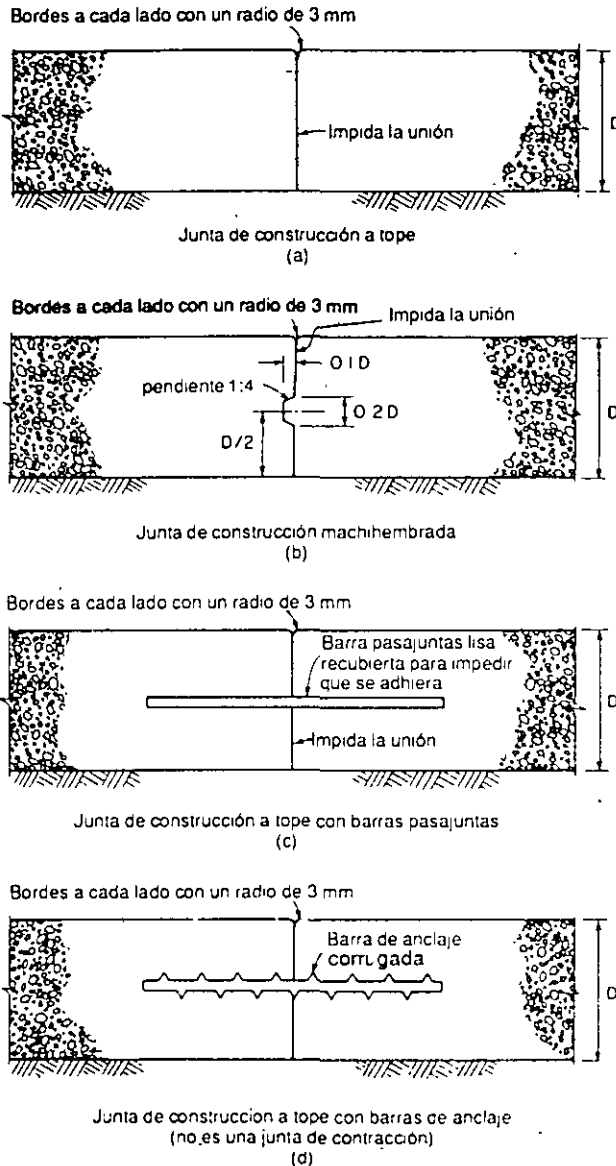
Las juntas de construcción son los lugares en que se detiene el proceso de construcción. Las juntas de construcción a, b, y c también se pueden usar como juntas de contracción.
